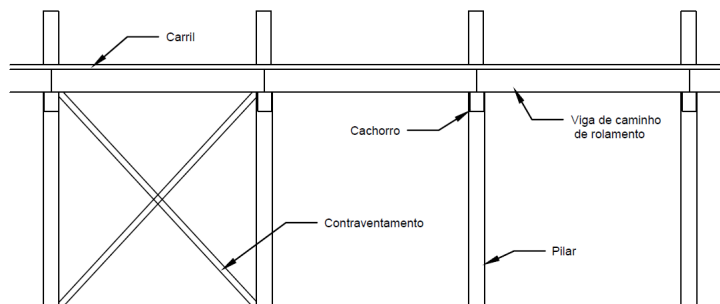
Vista em alçado de um pórtico com pontes rolantes.
